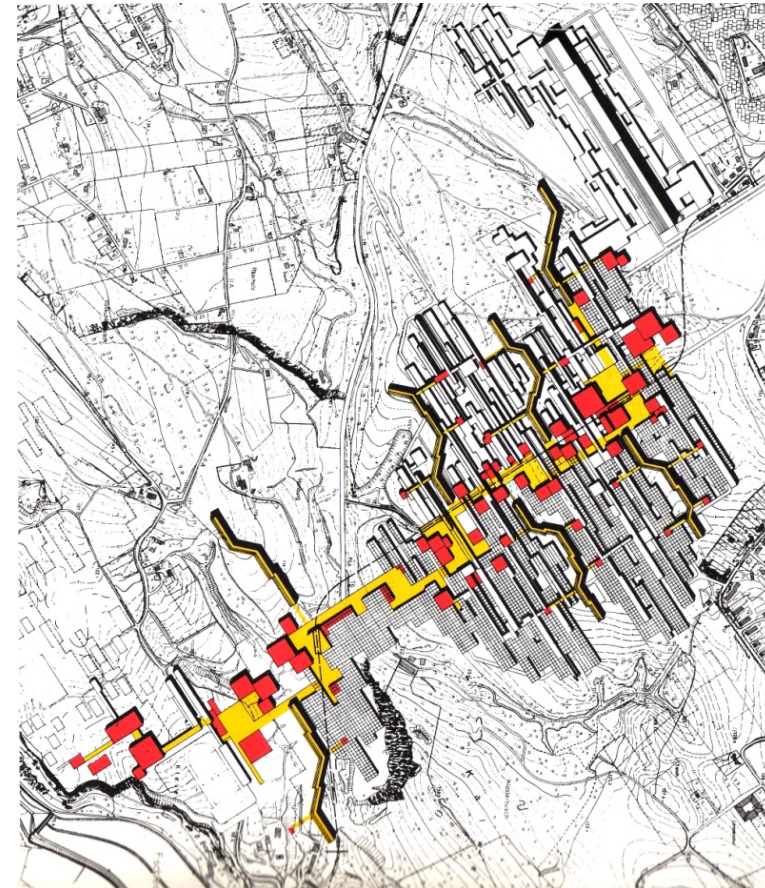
Planta de Conjunto Universidad de Bochum.
